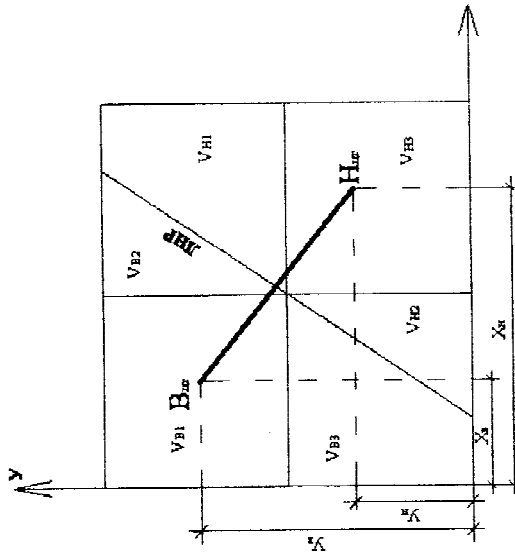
Схема к определению среднего расстояния перемещения грунта аналитическим методом
